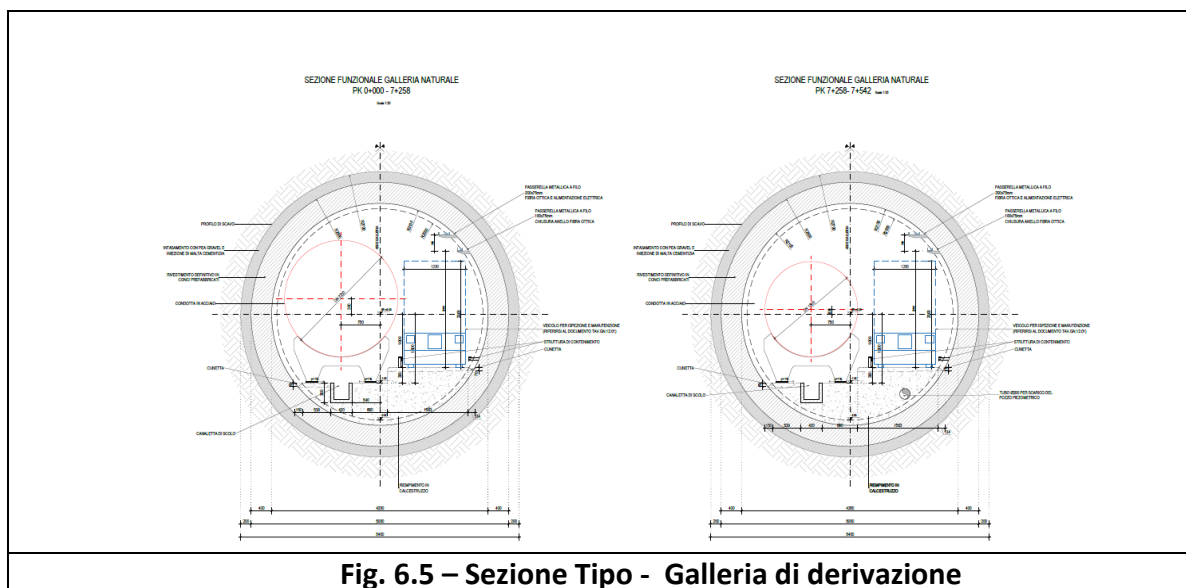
Sezione Tipo - Galleria di derivazione
